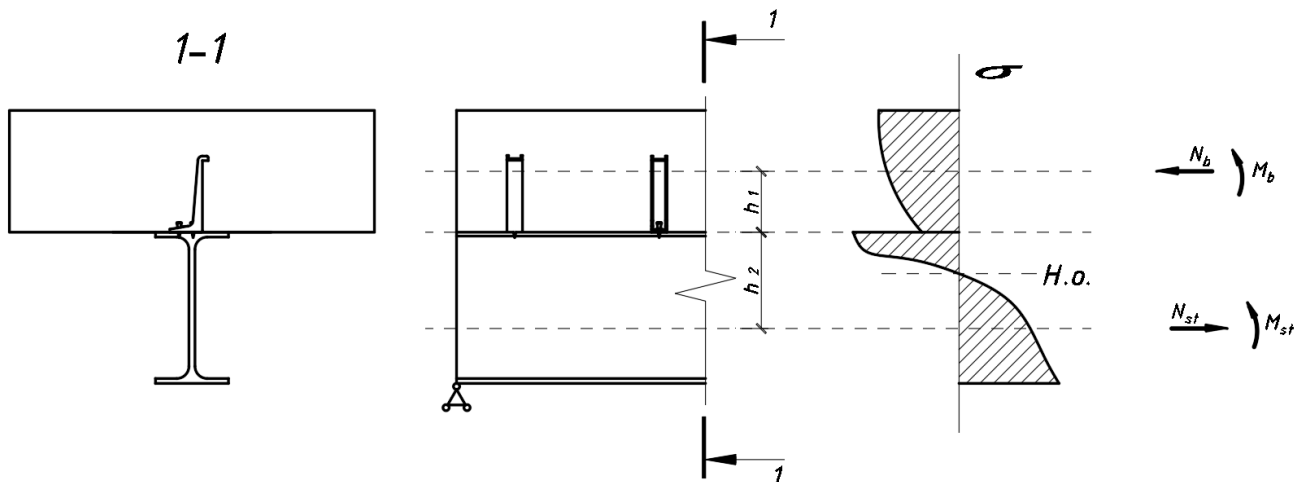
Напряженно-деформируемое состояние сталежелезобетонного перекрытия
